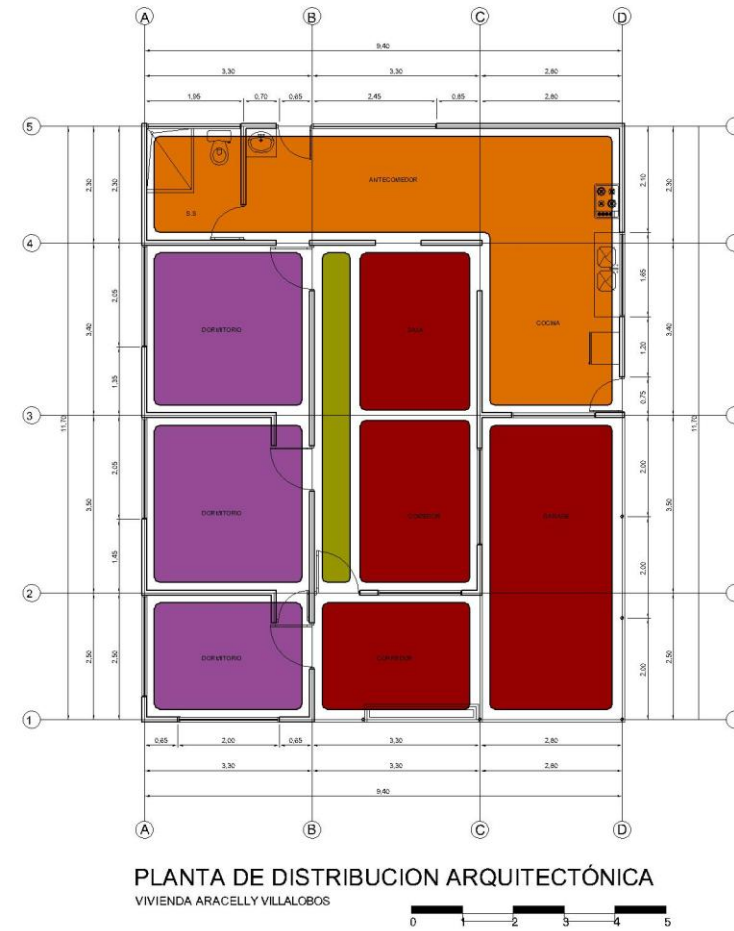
Vivienda Arcelly Villalobos. Planta Distribución con garaje. San Isidro, Heredia. 2008. Fuente: Personal.
